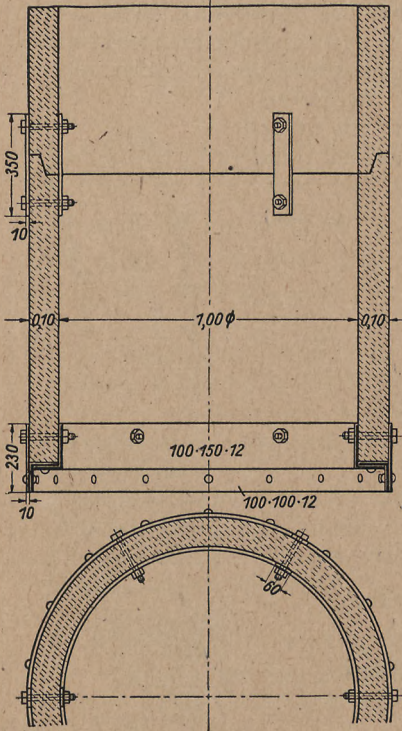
Betonbrunnenringe mit Bewehrung der Schneide und Sicherung des Stoßes
